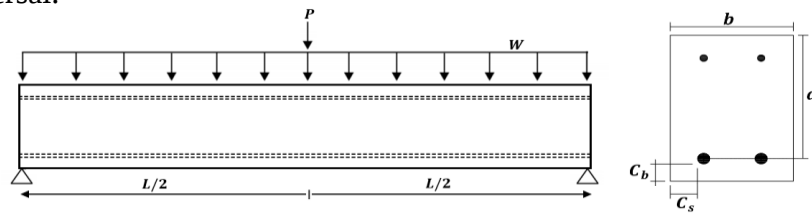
Carregamento e detalhamento transversal das vigas de Simonetti (2008).
